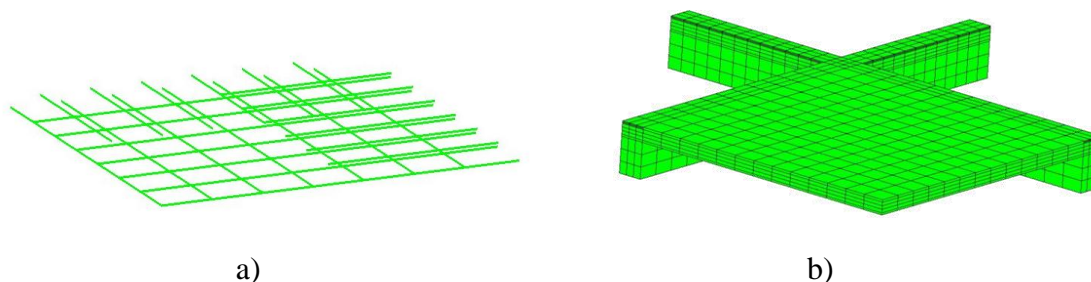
Malla de elementos finitos: a) acero de refuerzo y b) concreto simple
